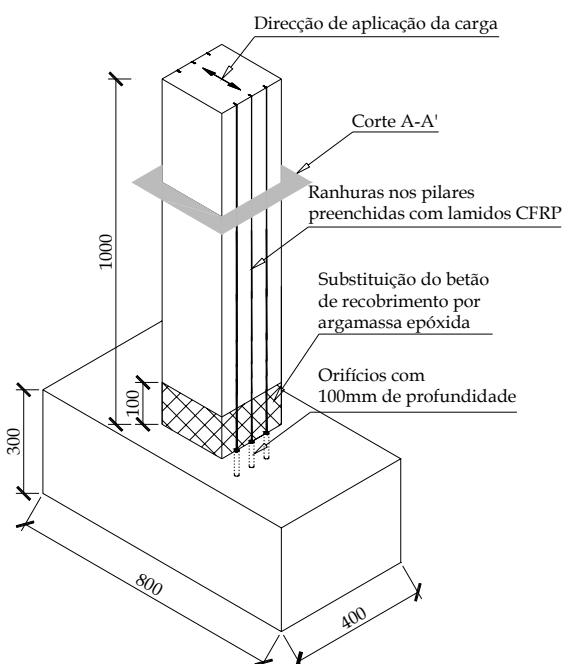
Técnica de reforço aplicada nos pilares (dimensões em milímetros).
